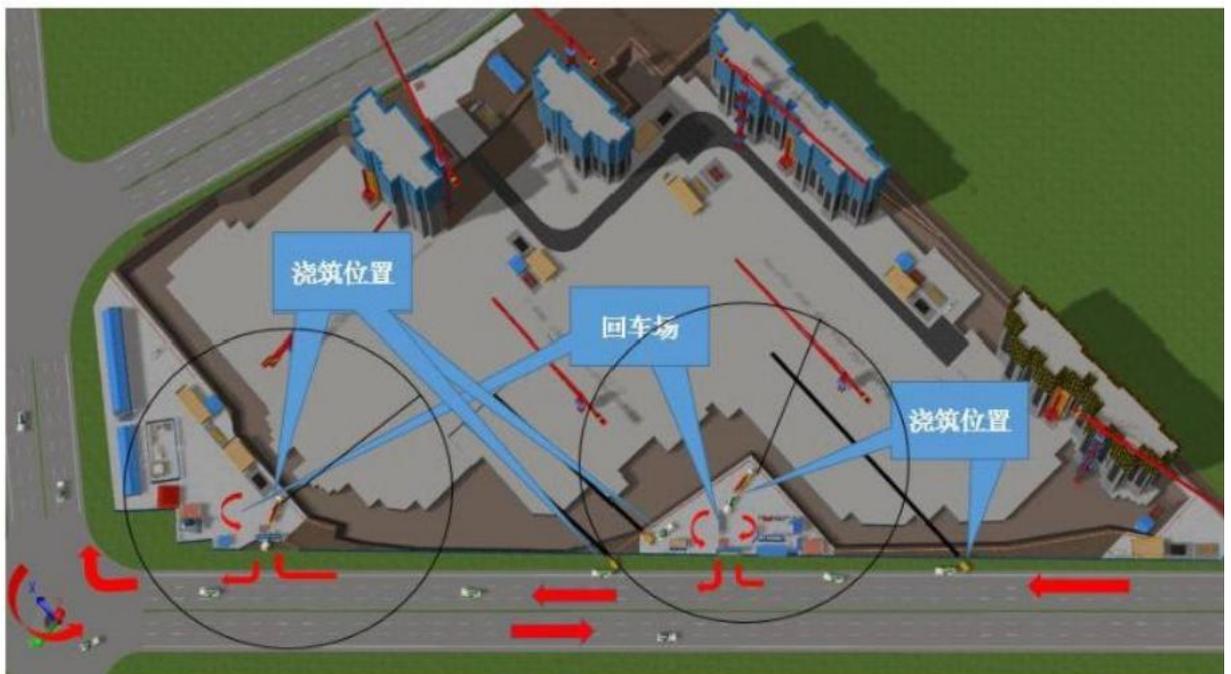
二施工区运输车辆路线、泵管及浇筑位置布置图
